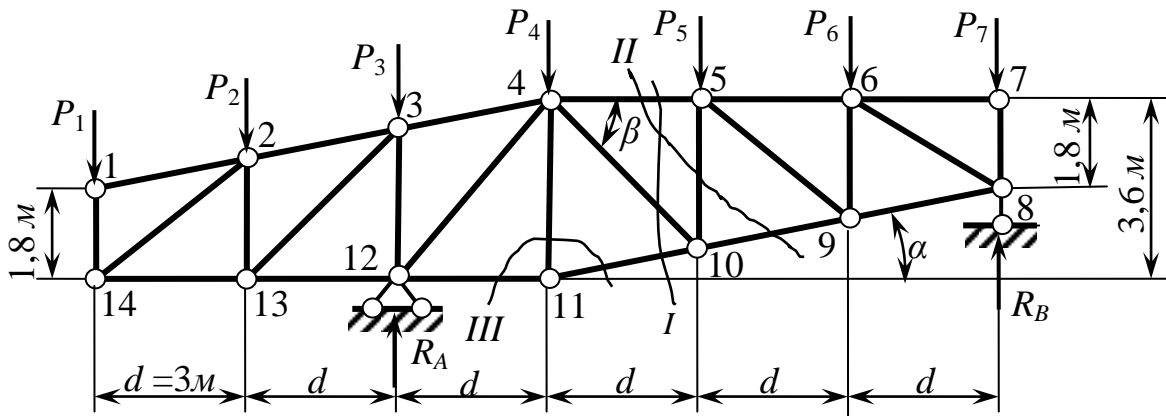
Расчётная схема фермы с узловой постоянной нагрузкой
